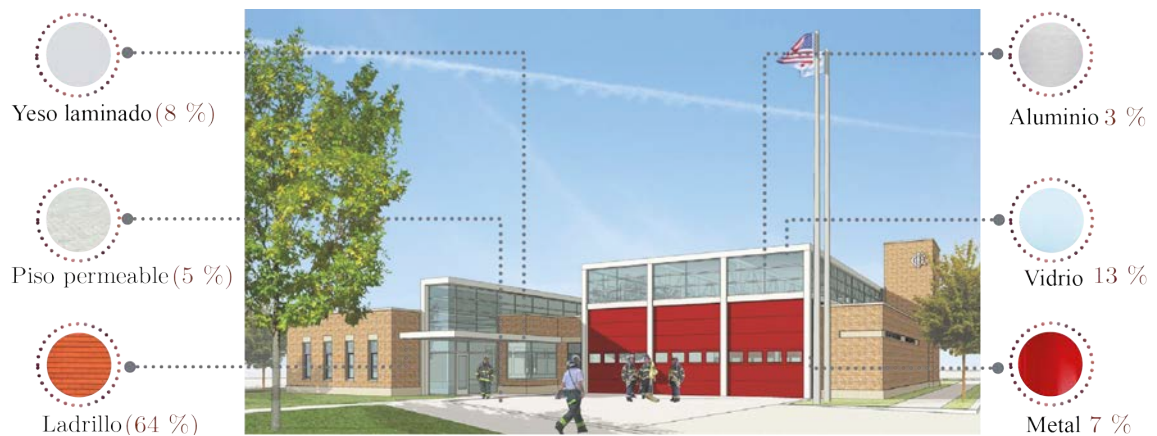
Análisis de materiales de la Compañía de bomberos n°16, Chicago. Fuente: [McGuire \(2018\)](#). Elaboración: Propia
